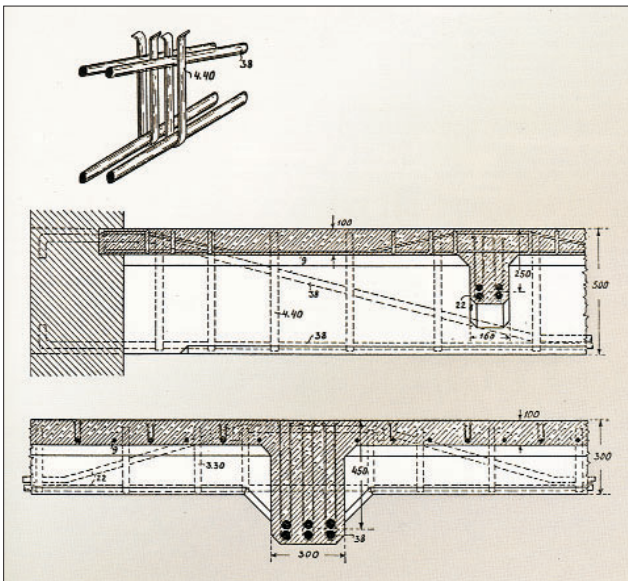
Plattenbalken mit Bewehrung nach Hennebique [16]
